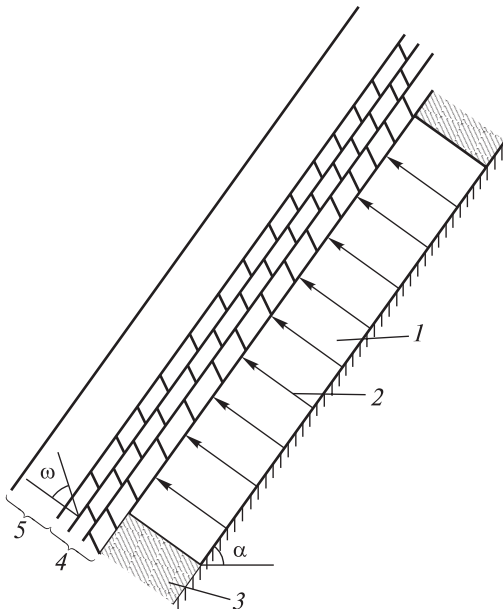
Схема к определению рабочего сопротивления стоек при трещиноватой слоистой непосредственной кровле:
